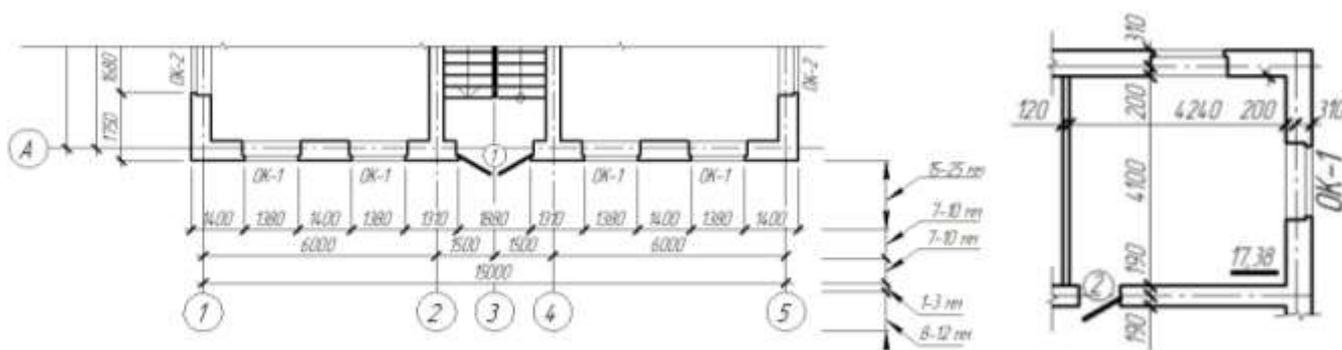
Требования к нанесению размеров на плане этажа: наружных и внутренних
